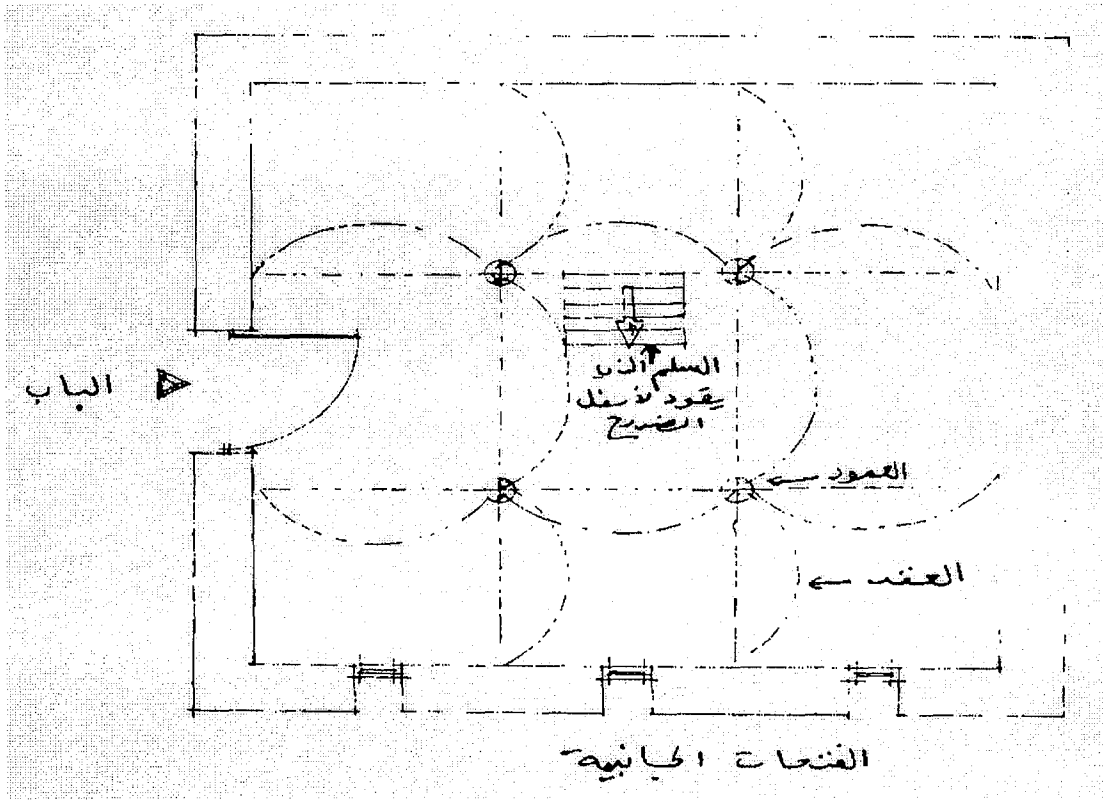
مخطط أفقي لضريح سيدي الأخضر بن خلوف
